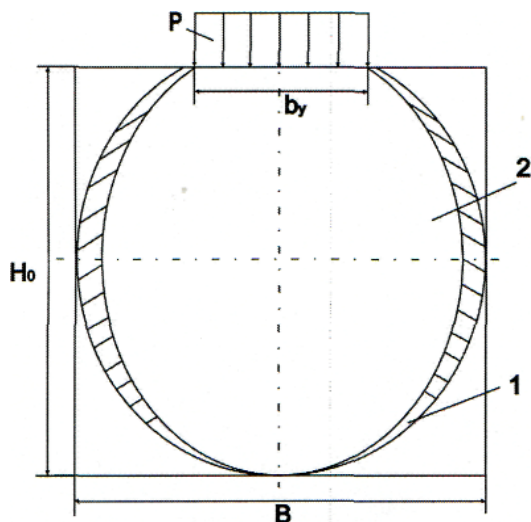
Расчетная схема грунтового основания с учетом его физической толщины H_0 : 1 – контур развития пластических областей; 2 – область грунта, в котором бурятся горизонтальные скважины; b_1 – ширина фундамента; B – ширина грунтового основания в форме прямоугольника; P – распределенная нагрузка
